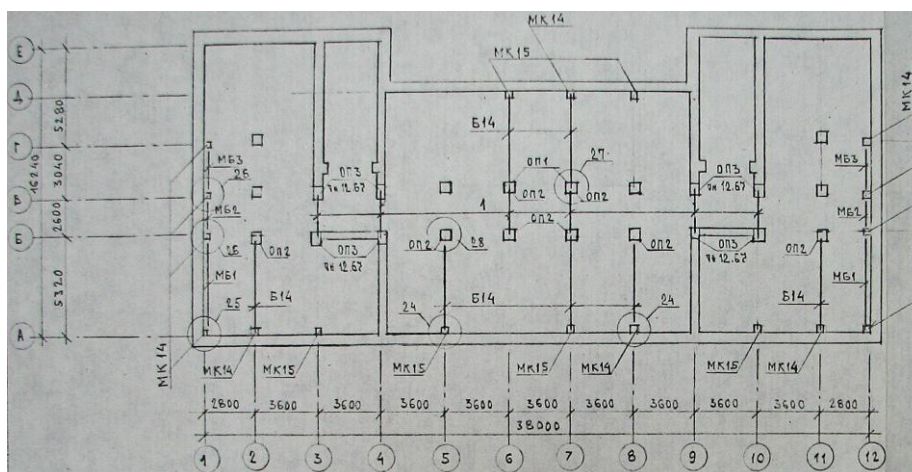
Жилой дом по пр. Мира, д. 122Б. Схема расположения монолитных колонн и сборных балок 4 этажа
